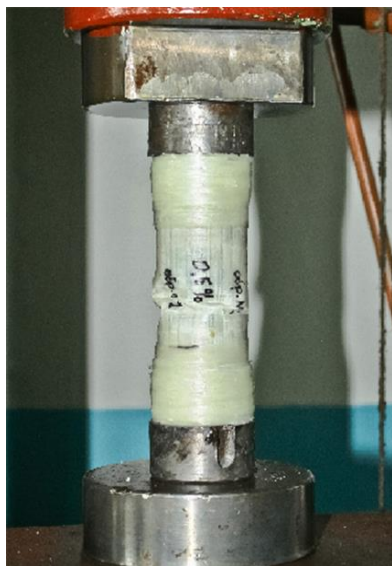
Образец трубчатого элемента в приспособлении для испытаний
